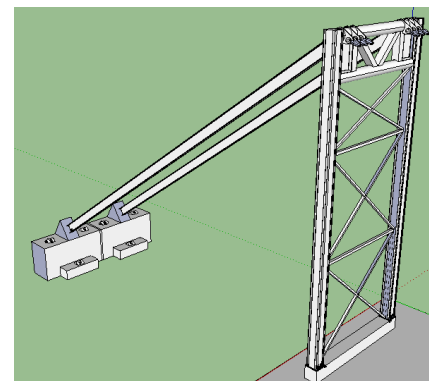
Detalle unión perfil W con varillas #8 (Elaboración propia, SketchUp)
